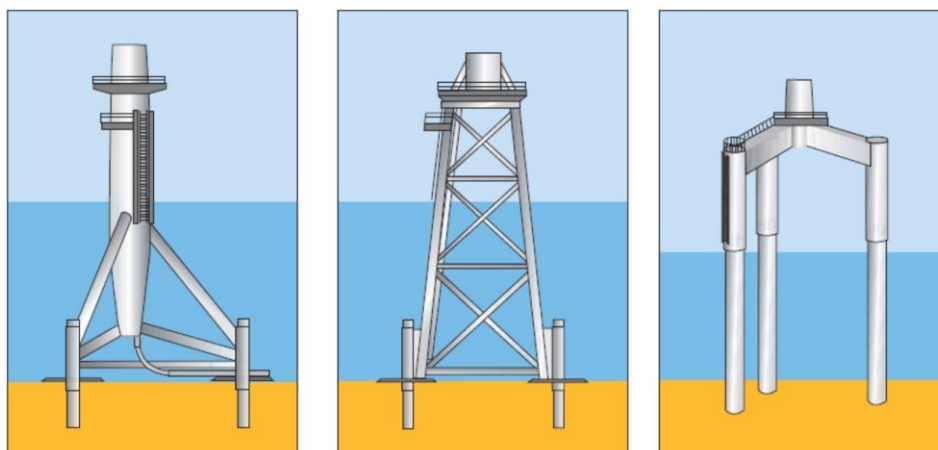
Exemplos de estruturas metálicas fixas do tipo *Tripod/Jacket* (extraído de [5]).
